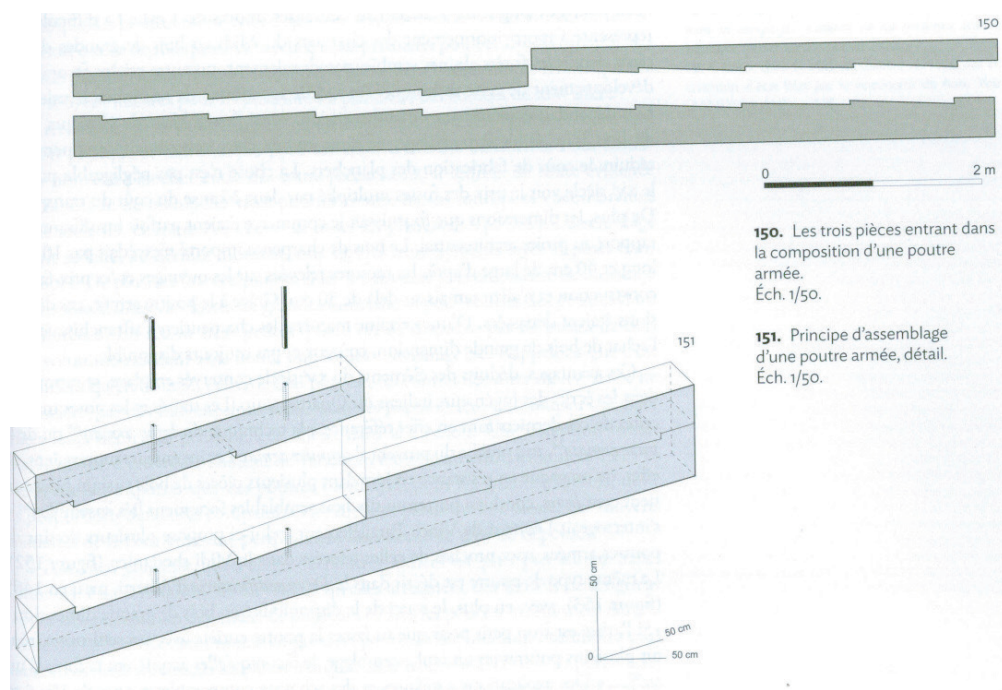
(en haut) : Principe d'assemblage d'une poutre armée. Dessin tiré de E. Bouticourt, «Charpente méridionale. Construire autrement : le Midi rhodanien à la fin du Moyen Age».
